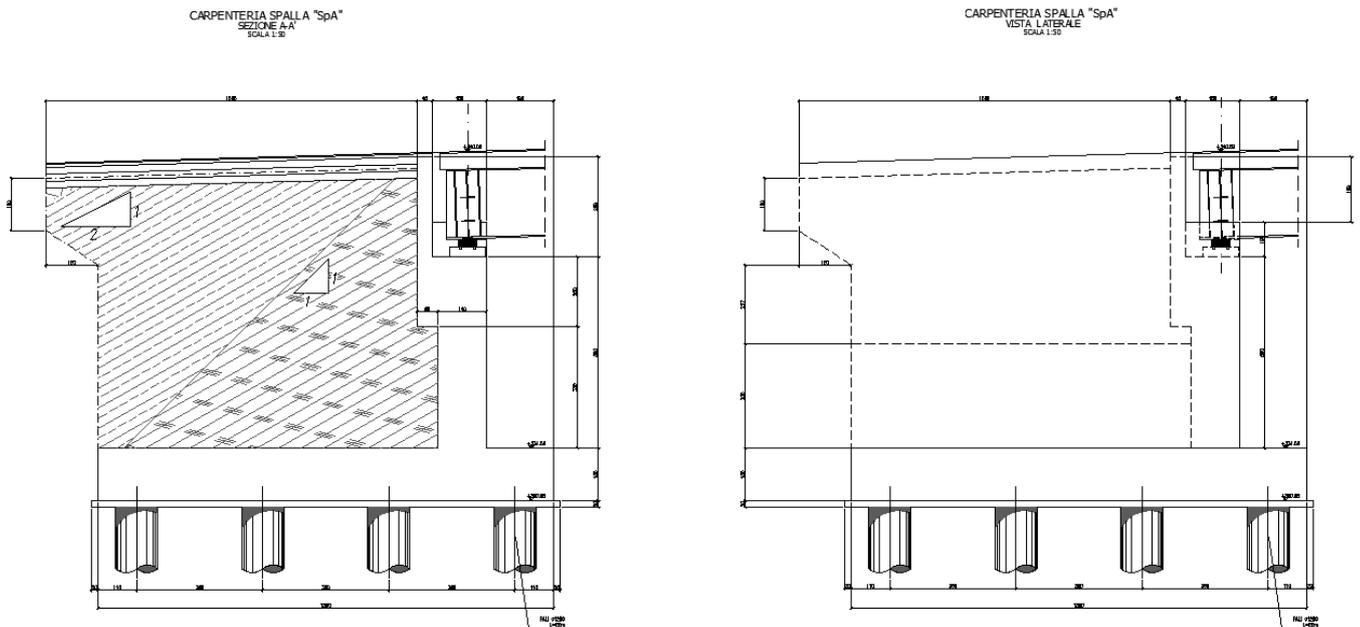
Sezione e vista longitudinale spalla A.
